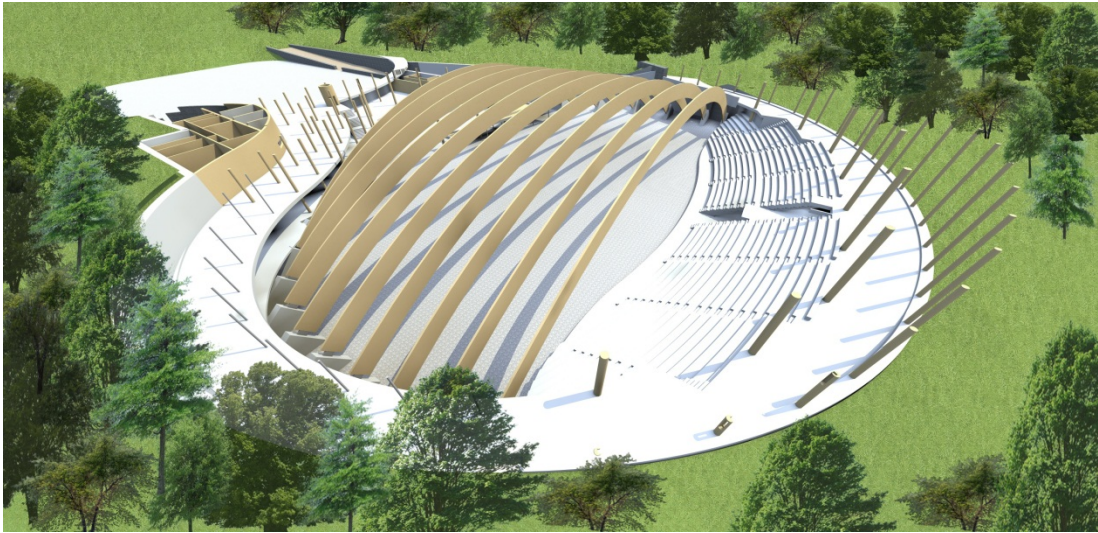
FASE DI CANTIERE – MONTAGGIO ARCHI 2
